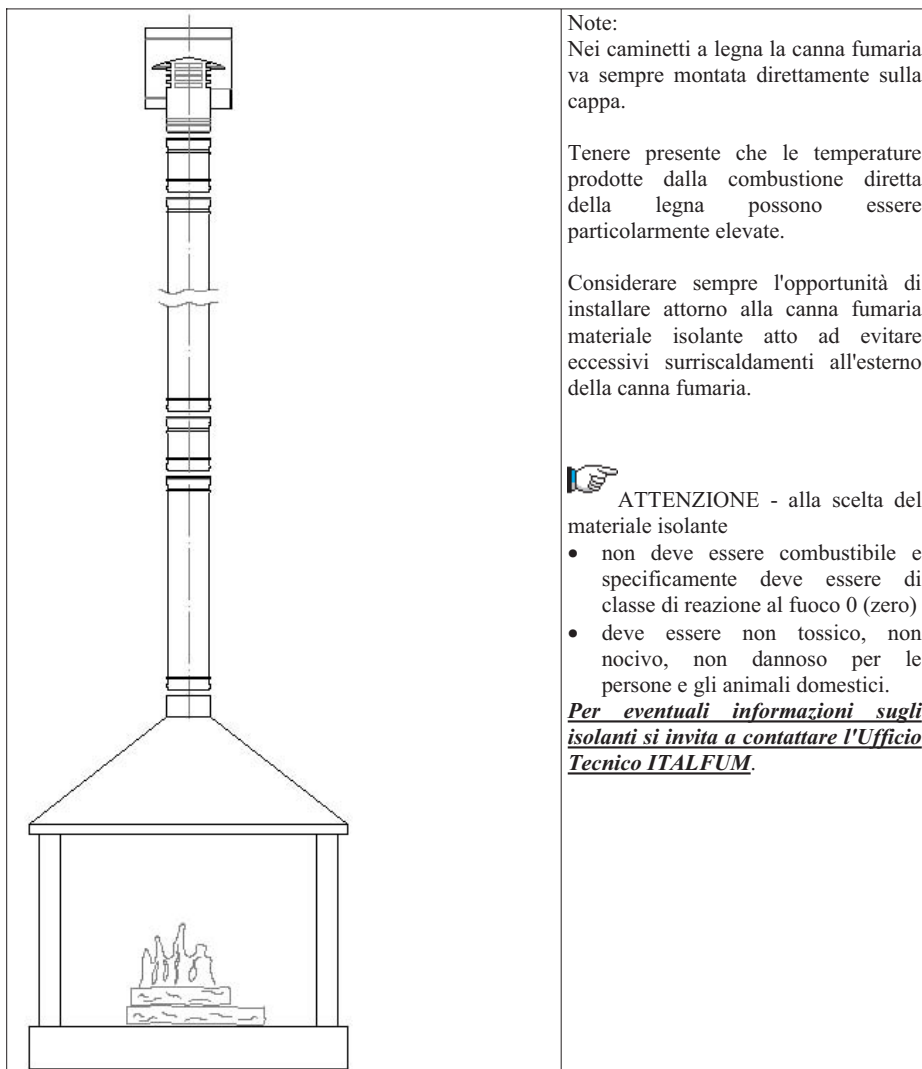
SCHEMA DI MONTAGGIO DI UN CAMINO SINGOLO
